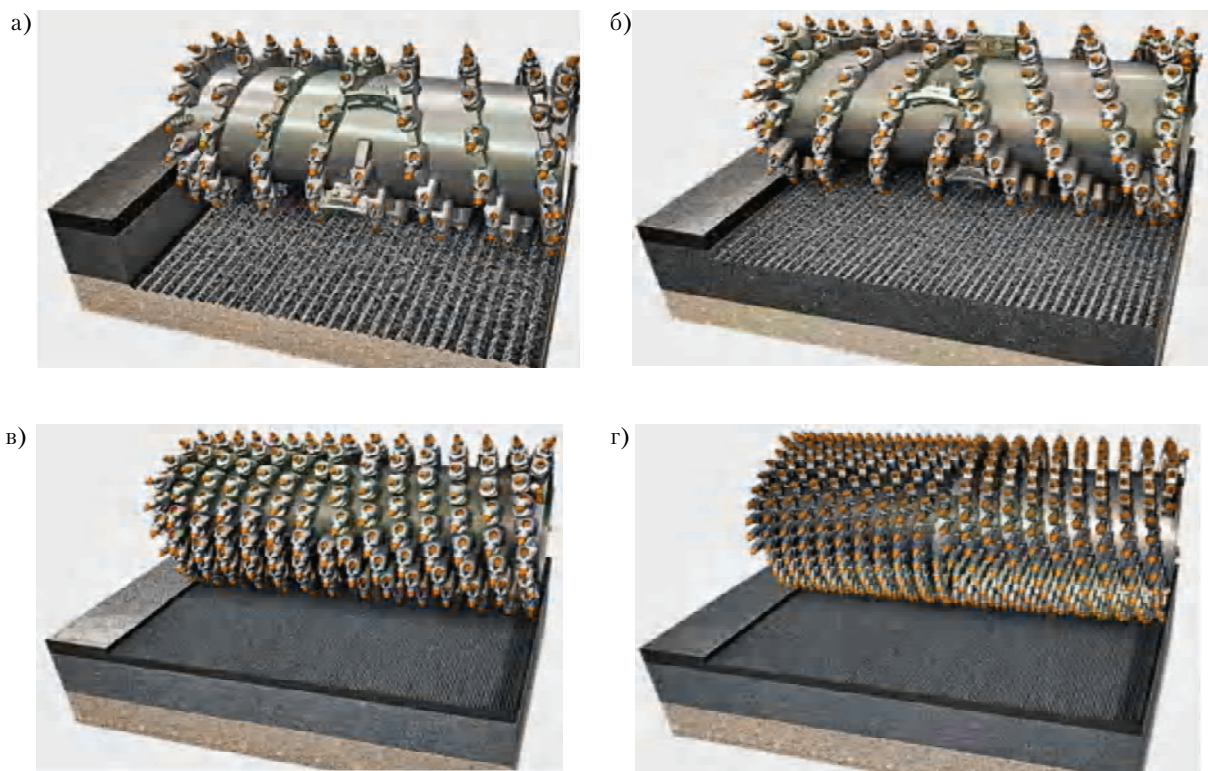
Виды рабочих органов дорожных фрез: а) черновой барабан; б) стандартный барабан; в) чистовой барабан; г) микрофрезерный барабан.
